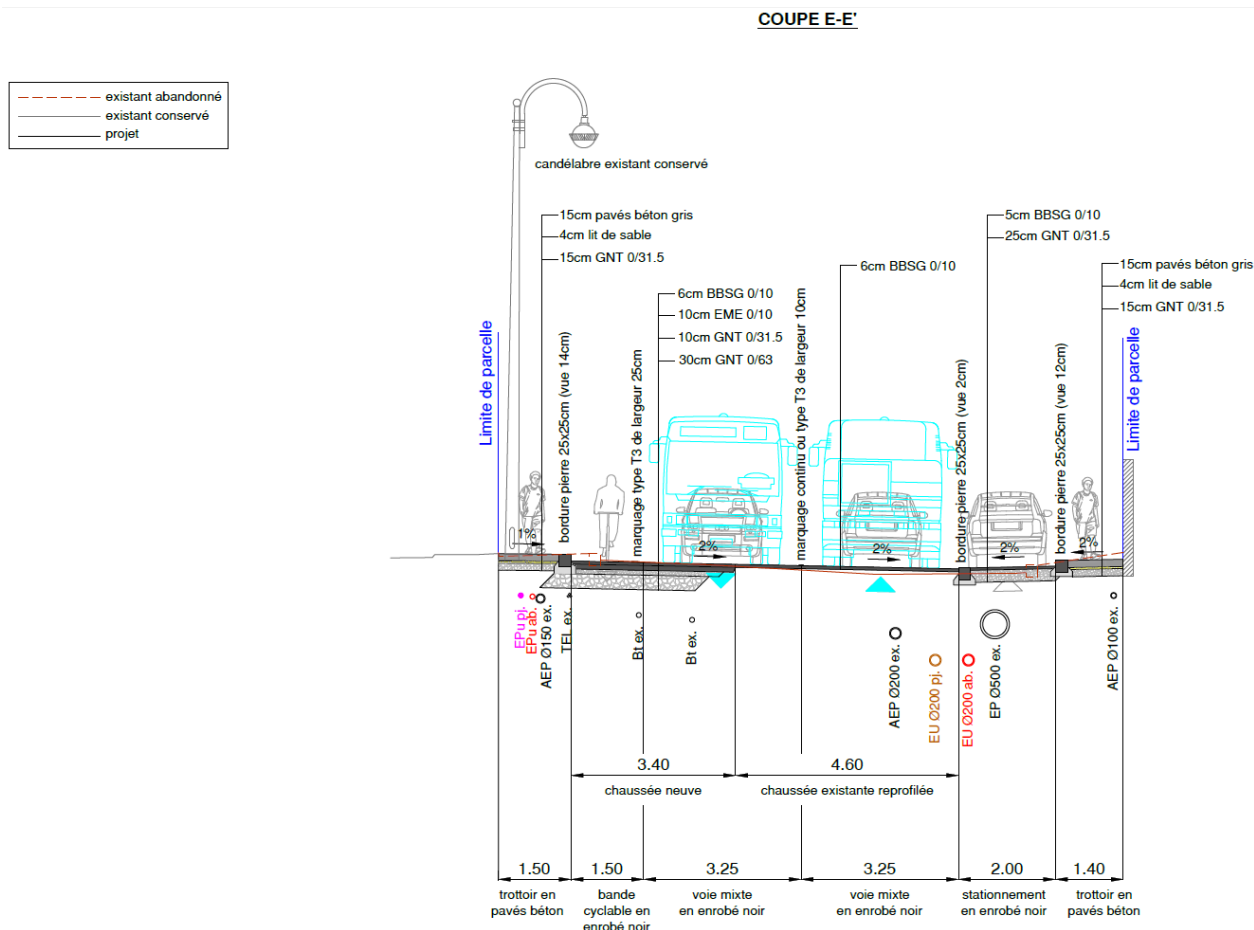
Profil en travers type de la rue Leconte de Lisle - section 5
